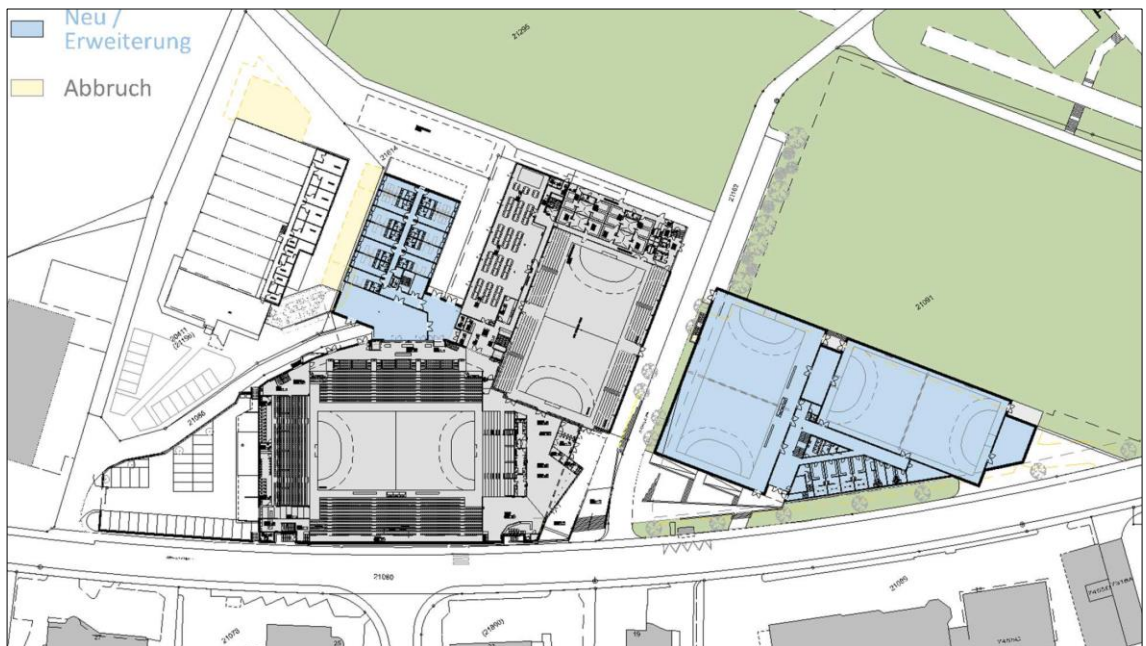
Grundriss des Richtprojektes mit Ost- (rechts) und Westteil (links)
